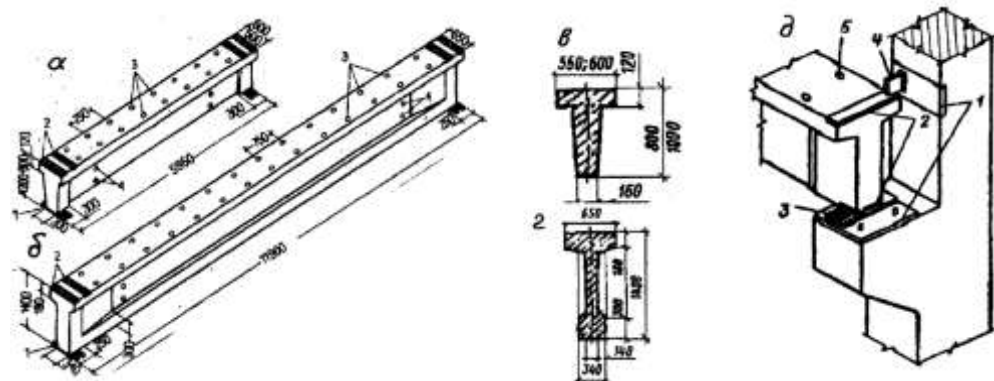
Збірні залізобетонні підкранові балки: а – таврового перерізу для кроку колон 6м; б – двотаврового перерізу для кроку колон 12м; в, г – поперечний перетин підкранових балок; д –кріплення підкранової балки до колони; 1 – закладні деталі колони; 2 – те ж підкранової балки; 3 - сталева планка (приварюється до опорної закладної деталі підкранової балки); 4 – сталевна накладка; 5 – отвори для кріплення рельса.
